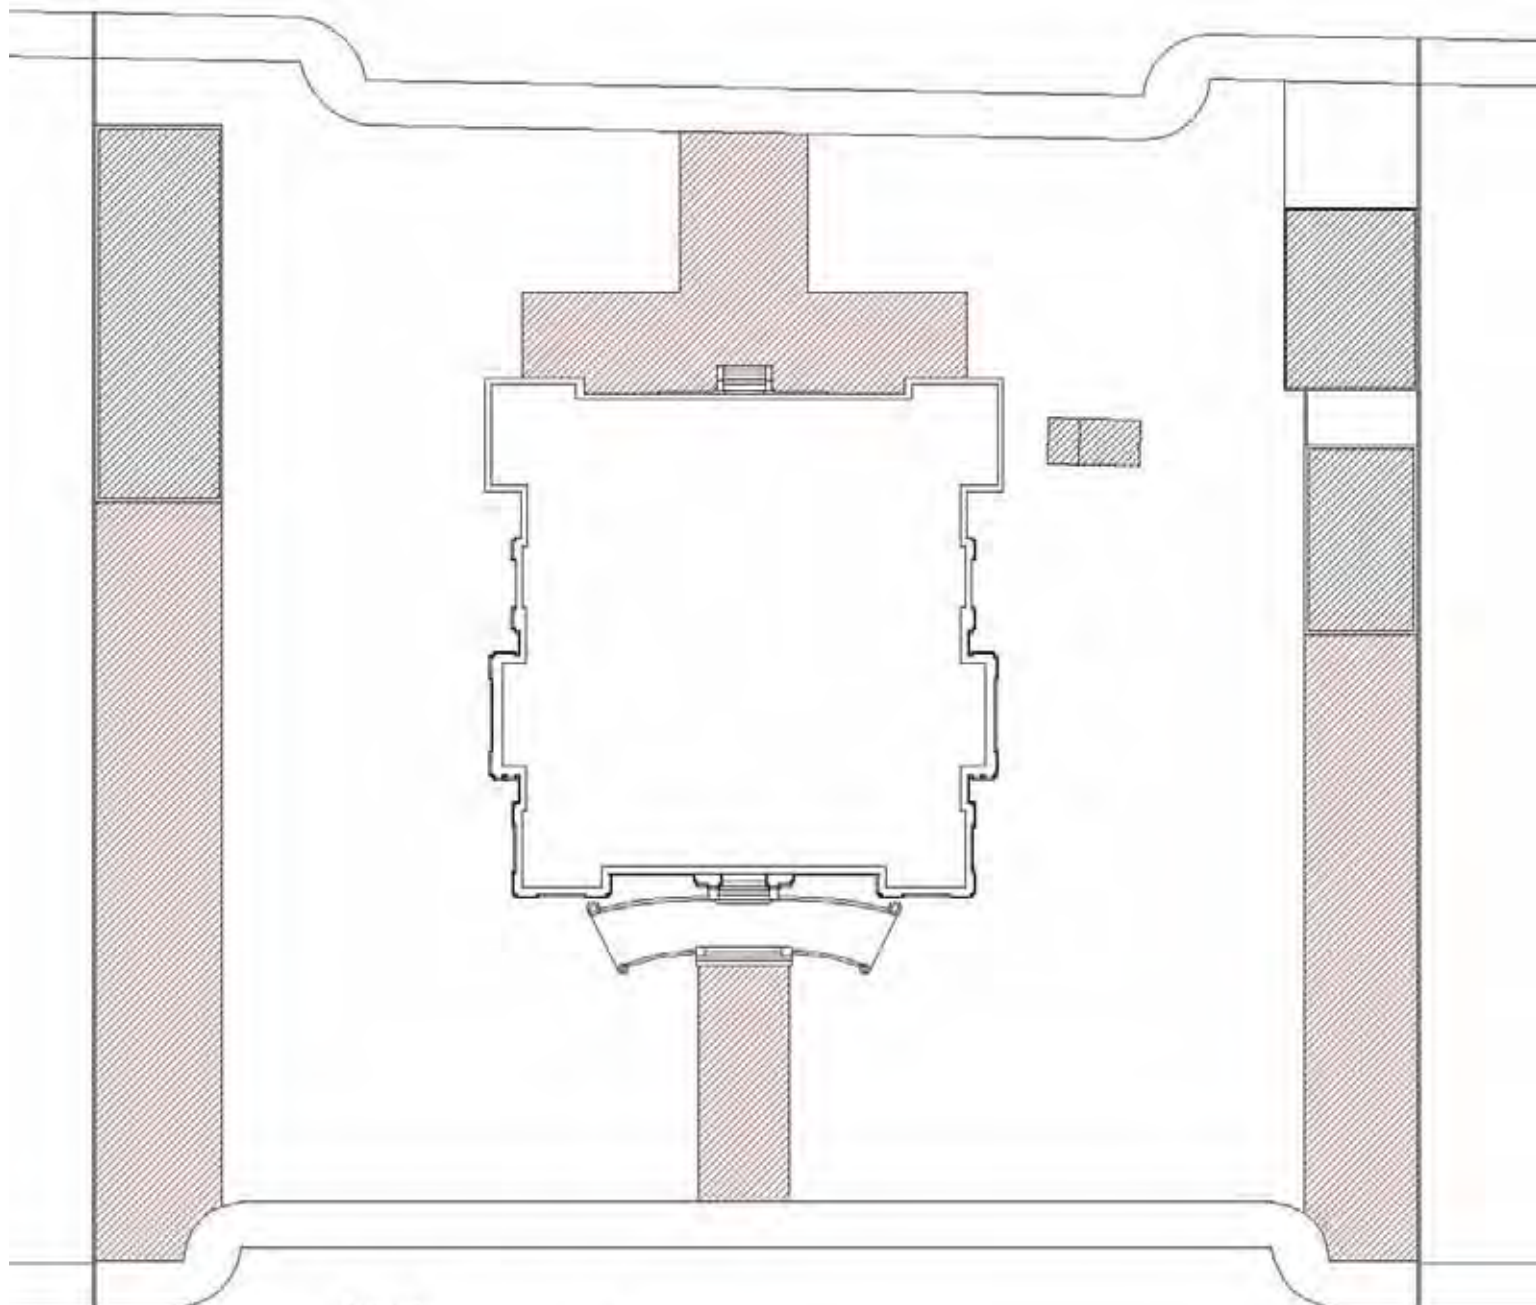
Desenho da Praça Rui Barbosa com placas de concreto
